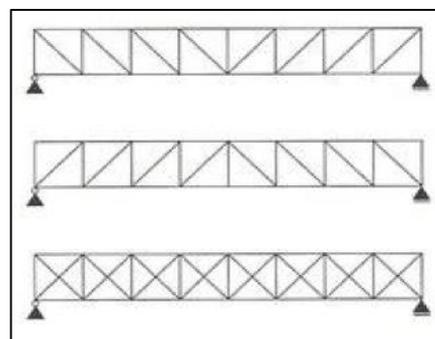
Les poutres à membrures parallèles(archiexpo.com)
